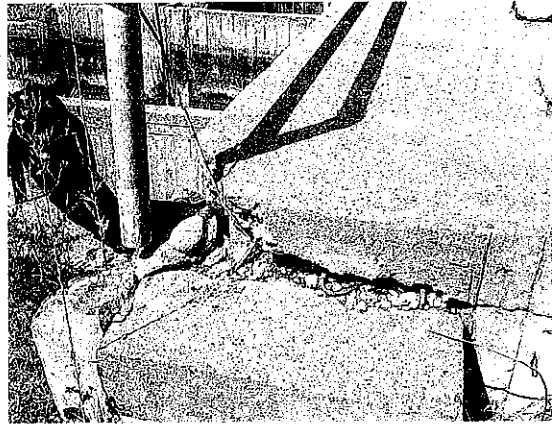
Losa apoyando sobre estribo (muro lateral)
